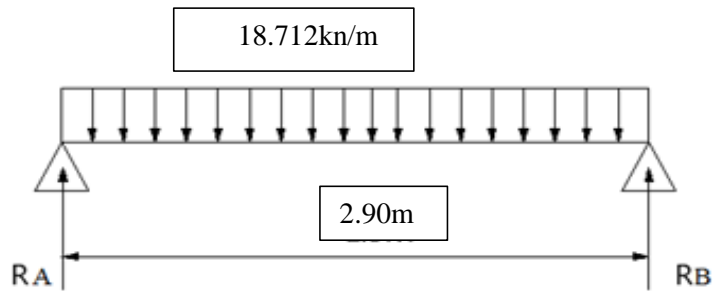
Schéma statique de la poutre palière a l'ELS.
